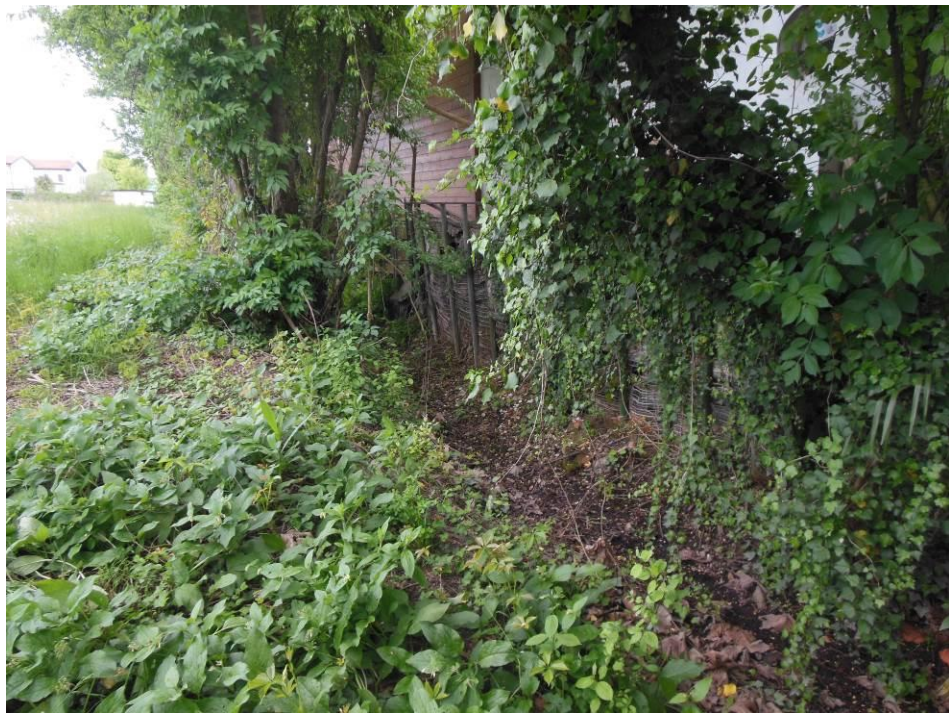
Fossato lungo il perimetro est della lottizzazione di progetto.
